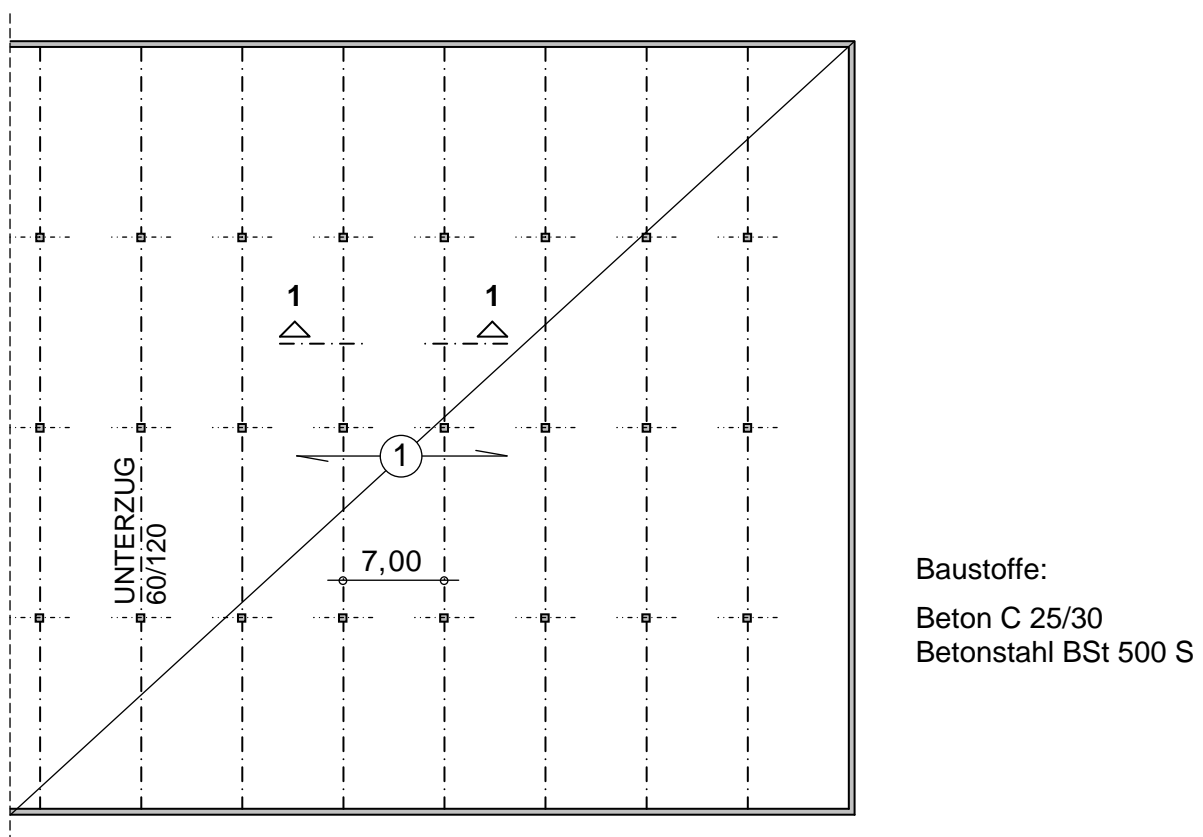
Geschossdecke einer Lagerhalle (Ausschnitt)
